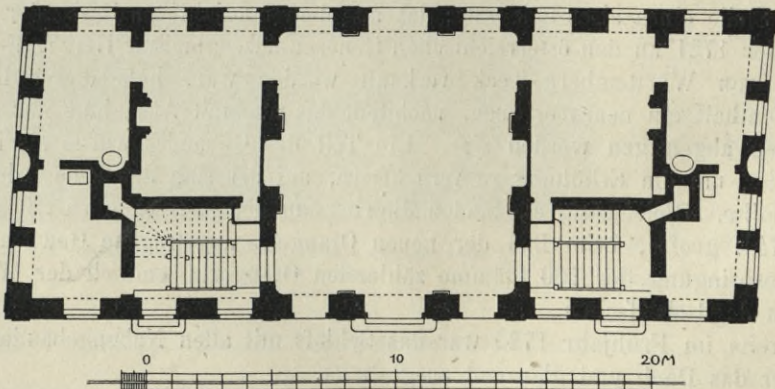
Neschwitz, Altes Schloß, Grundriß des Erdgeschosses.
